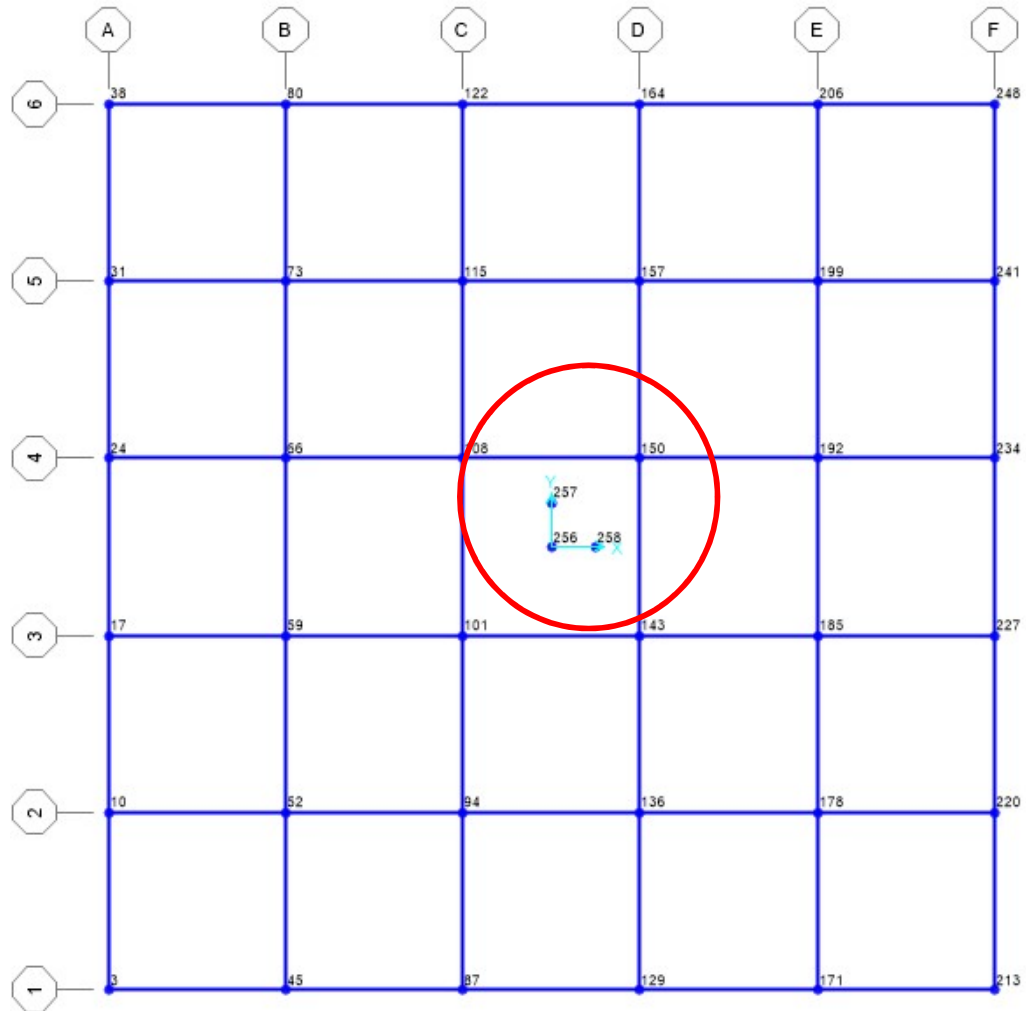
Vista en planta de la edificación y sus nodos de excentricidad accidental en cada planta (nodos 257-258)
